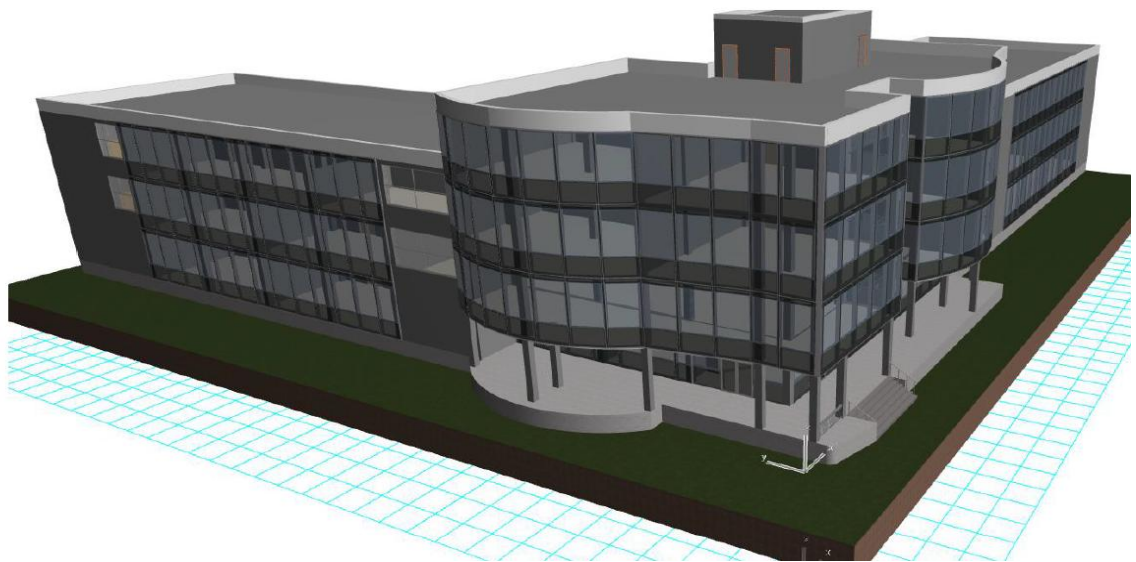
3D модель нового корпуса КнАГУ в ПК ArchiCAD
